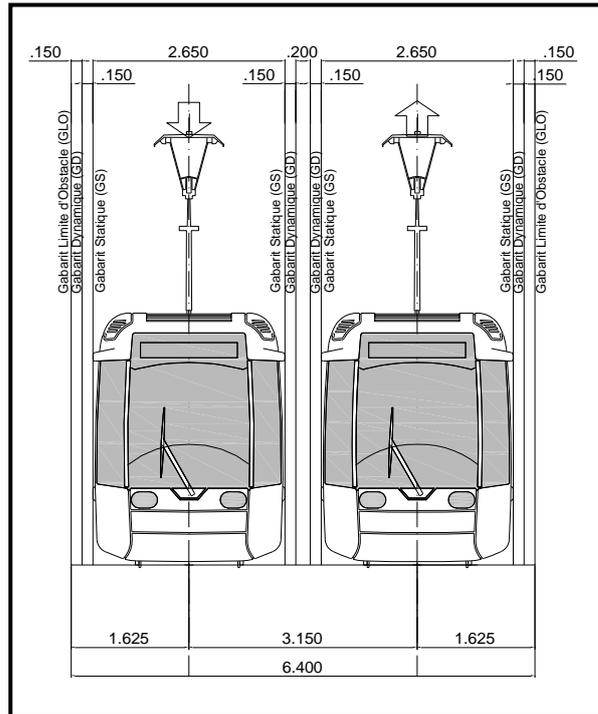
Coupe type en voie double avec poteaux latéraux ()
